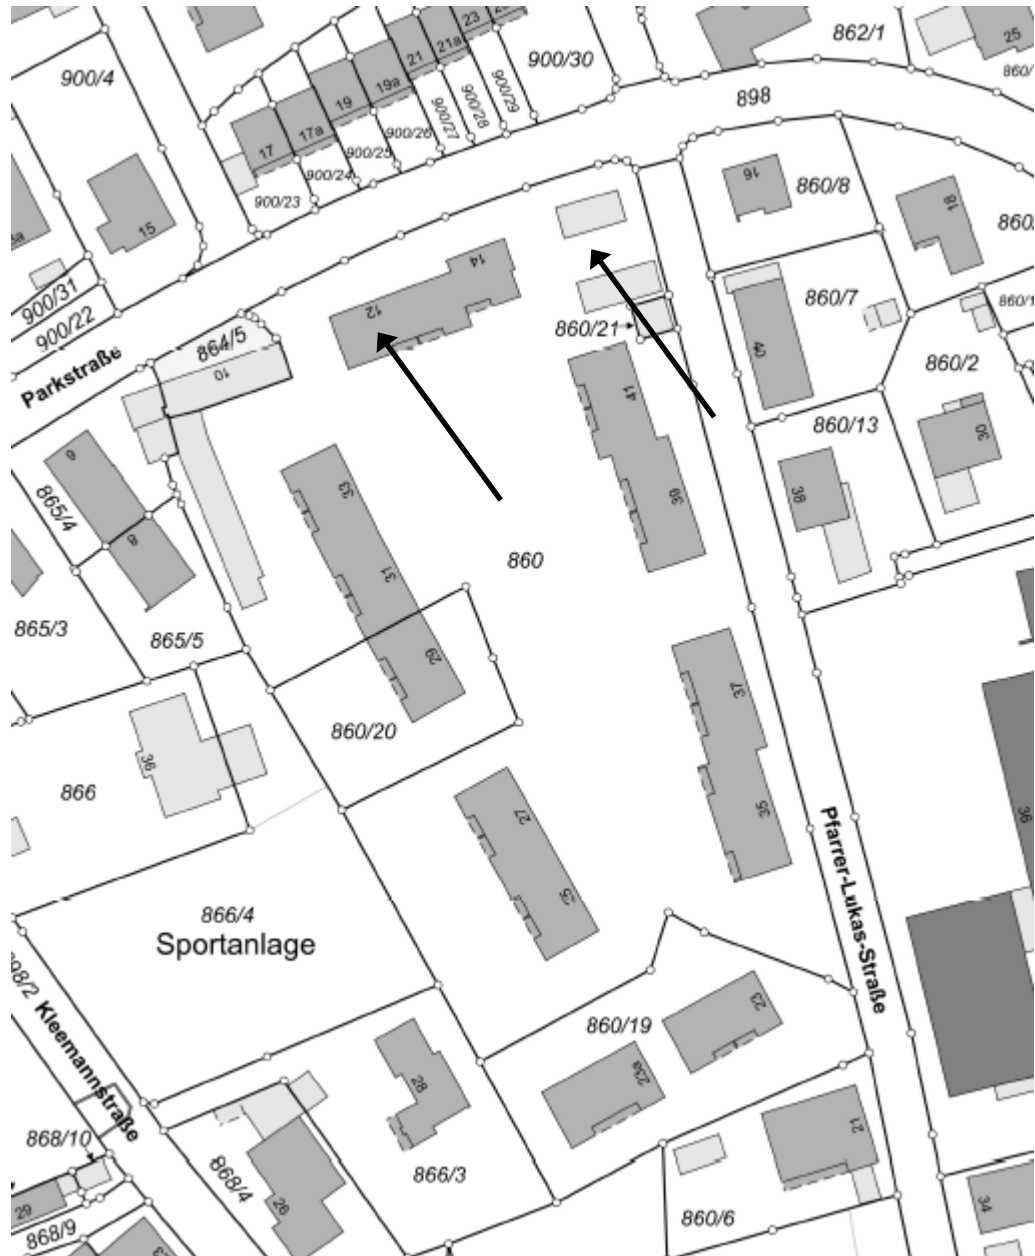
Lageplanausschnitt, Maßstab 1/1000
